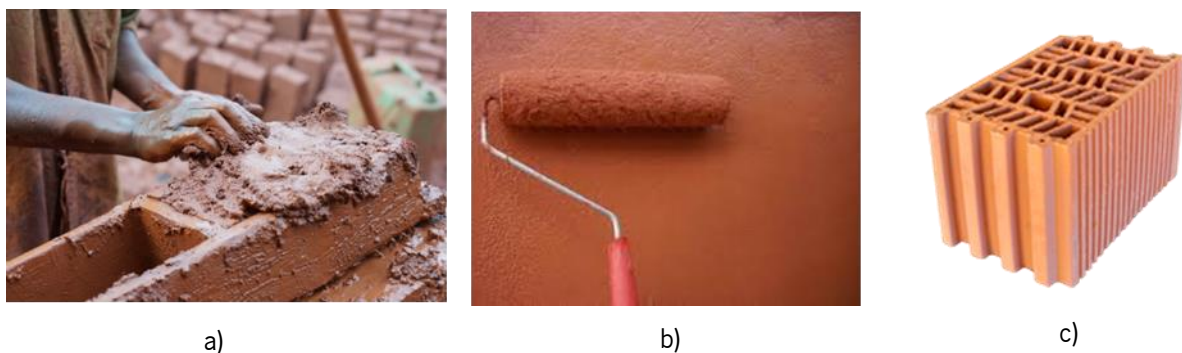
a) Produção de adobes (Nordin, 2020); b) Tinta de argila (Redação Pensamento Verde, 2016); c) Tijolo Cerâmico (Priceram, 2022)
